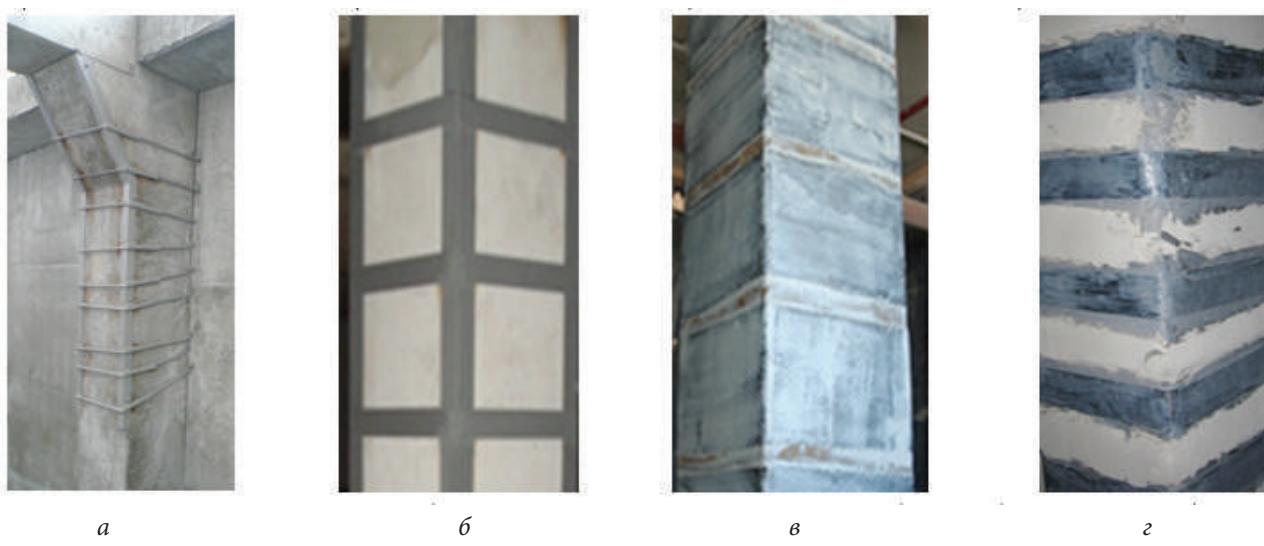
Усиление железобетонной колонны: а) – стальная рубашка; б) – стальная обойма;
